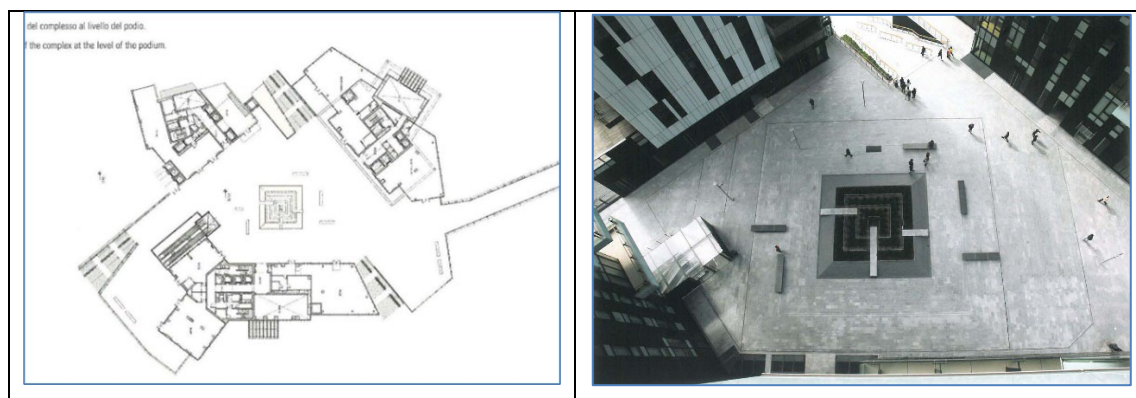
Planimetria e vista dall'alto di piazza Alvar Aalto.
